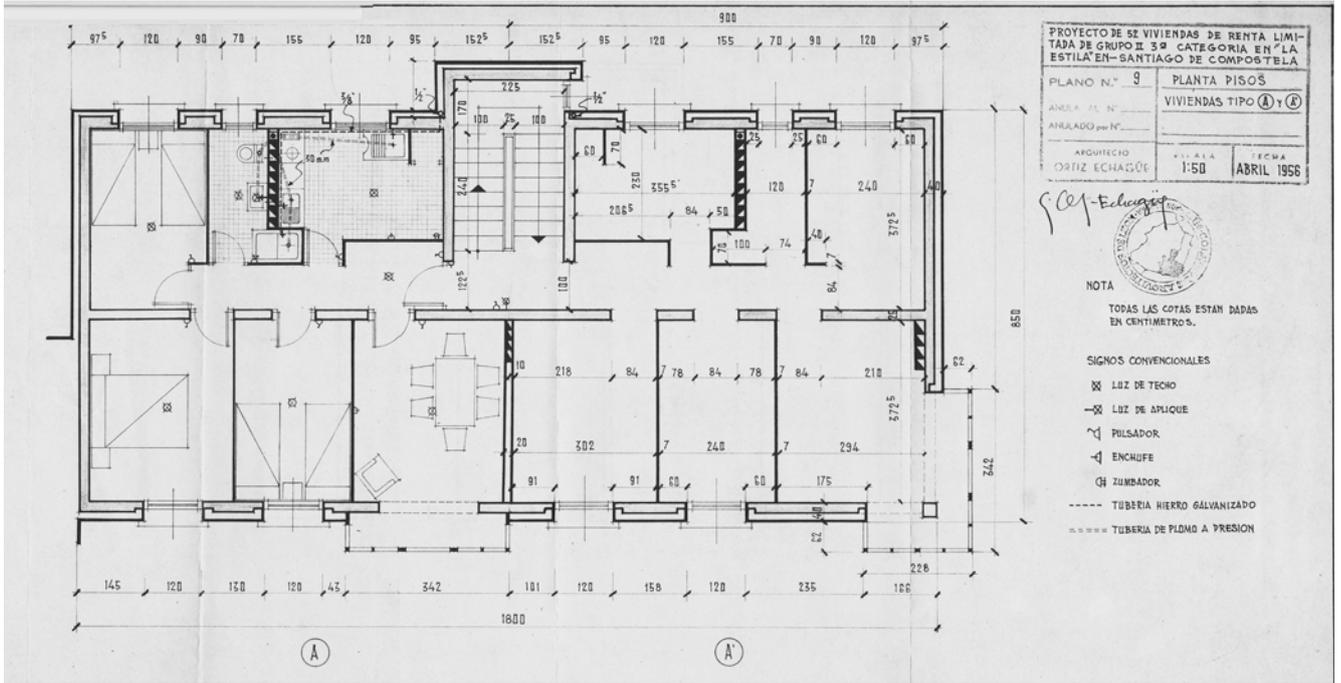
Plano N° 9. Planta de pisos: Viviendas tipo A y A', abril 1956.
